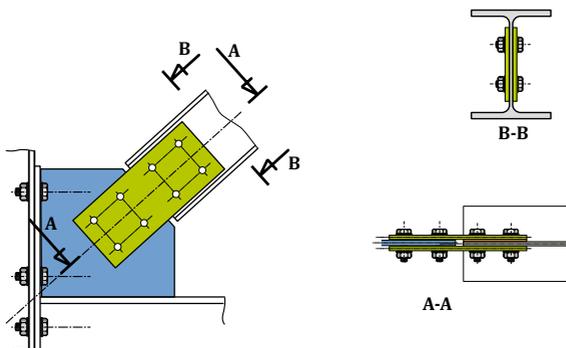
Assemblage par couvre-joints pour une diagonale à section laminée en H
